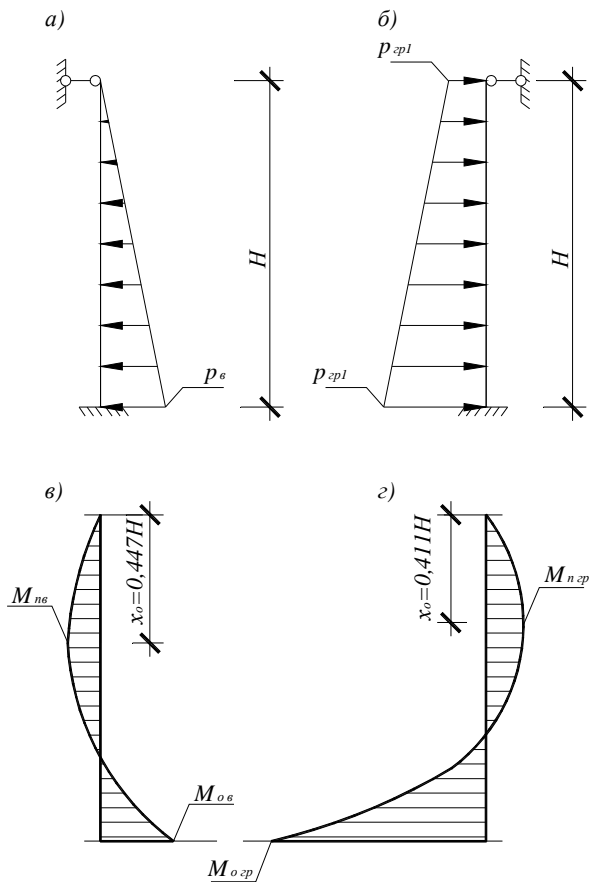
Расчетные схемы и эпюры моментов в стенке резервуара:
